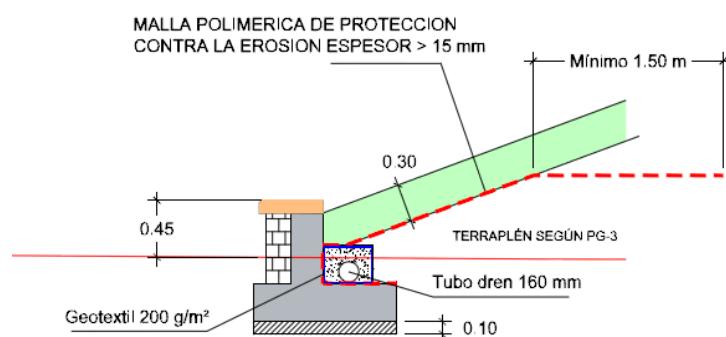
Construcción del muro de piedra en el talud para la protección contra avenidas.
